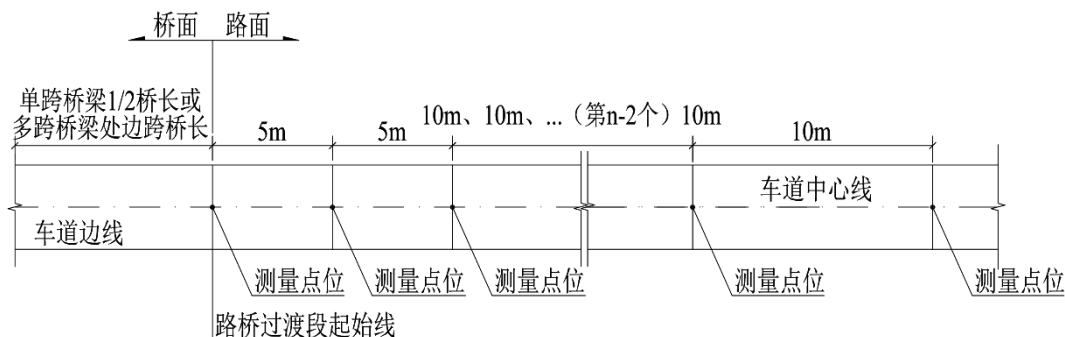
桥头设搭板时纵坡测量平面示意图
